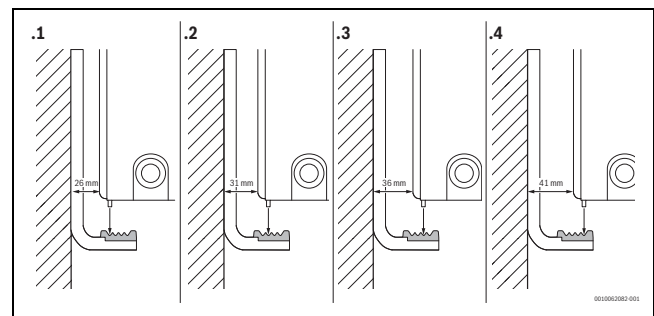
Opzioni di fissaggio delle staffe a parete per i radiatori VC-, VCM-, A- e C-Profil/ Plan di tipo 21, 22, 33
